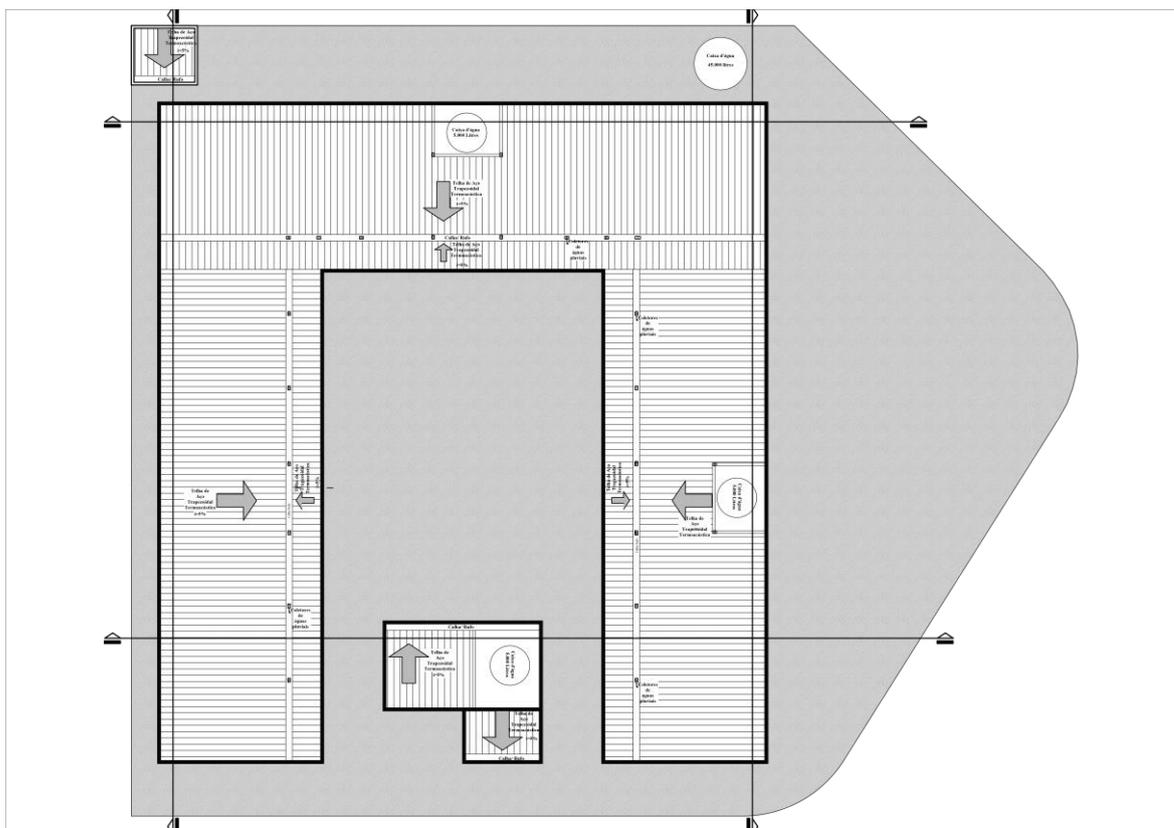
Planta de cobertura do projeto onde serão feitas as aplicações dos painéis solares. Fonte: Elaborado pelo autor
